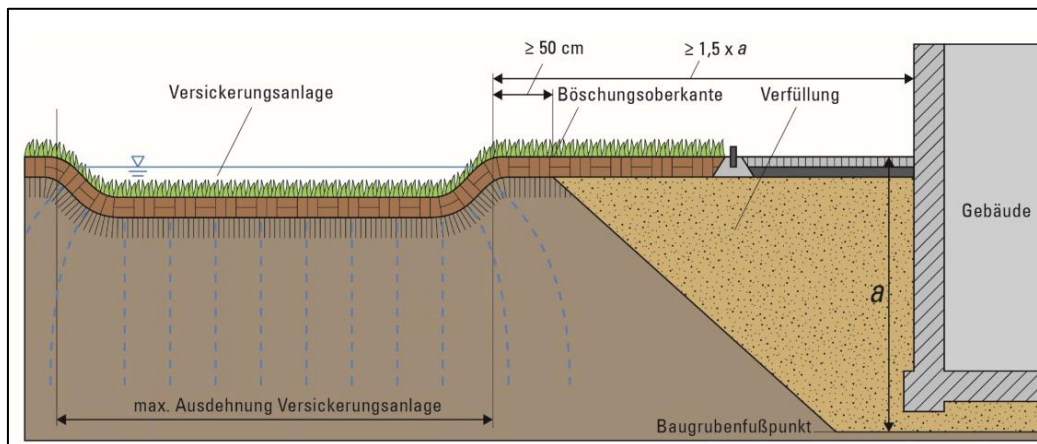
Mindestabstand dezentraler Versickerungsanlagen von Gebäuden ohne wasserdruckhaltende Abdichtung (DWA-A 138-1)
